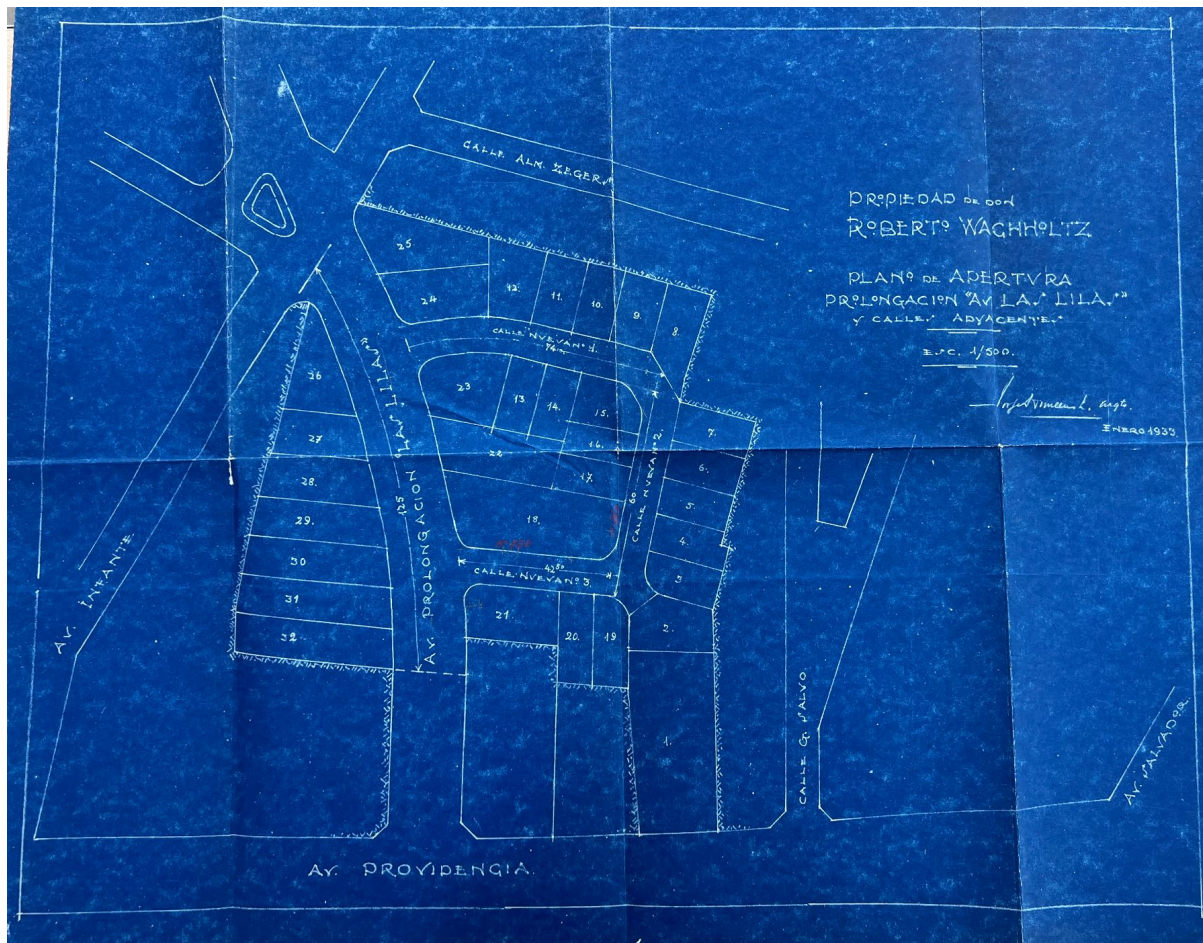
Plano loteo original año 1933 “Prolongación Av. Las Lilas”. Fuente: Departamento de Catastro, M. de Providencia.
